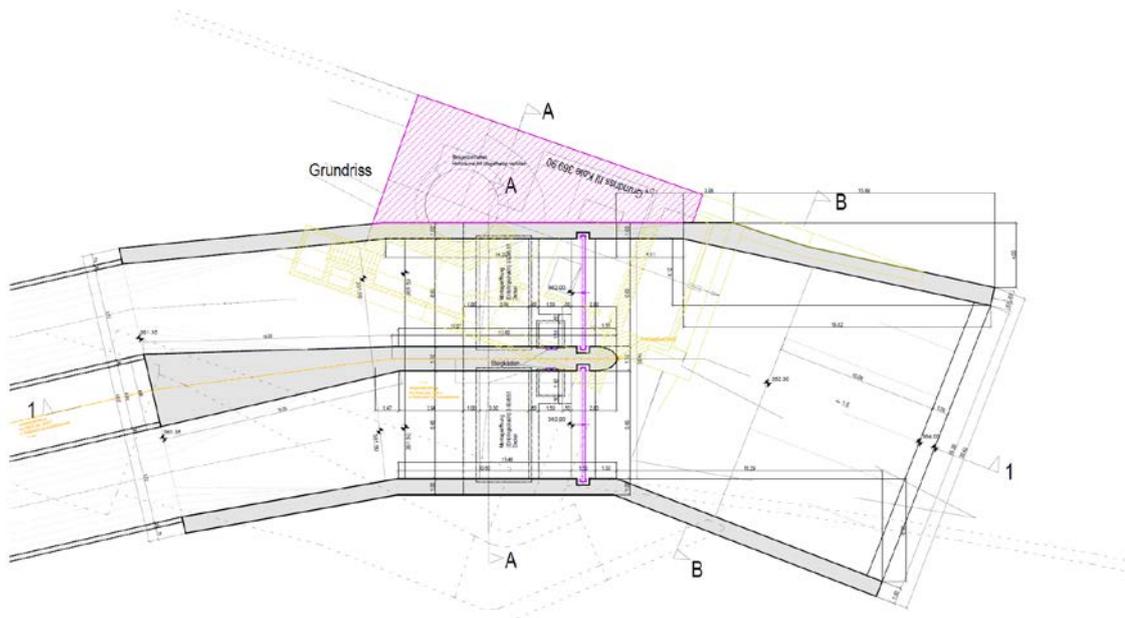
Grundriss Auslaufbauwerk
